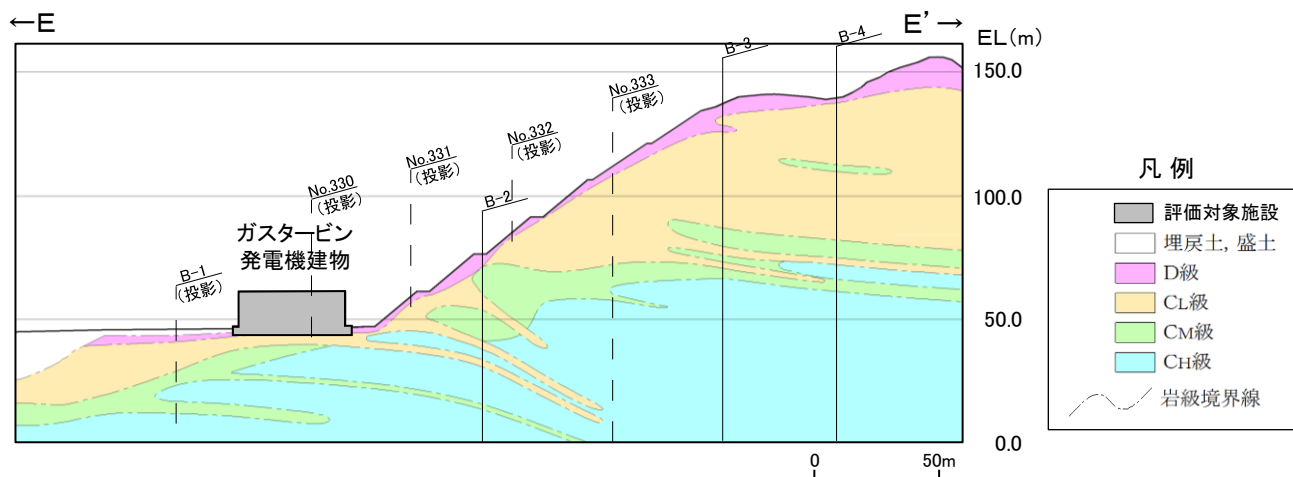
ガスタービン発電機建物の地質断面図 (E-E' 断面)
